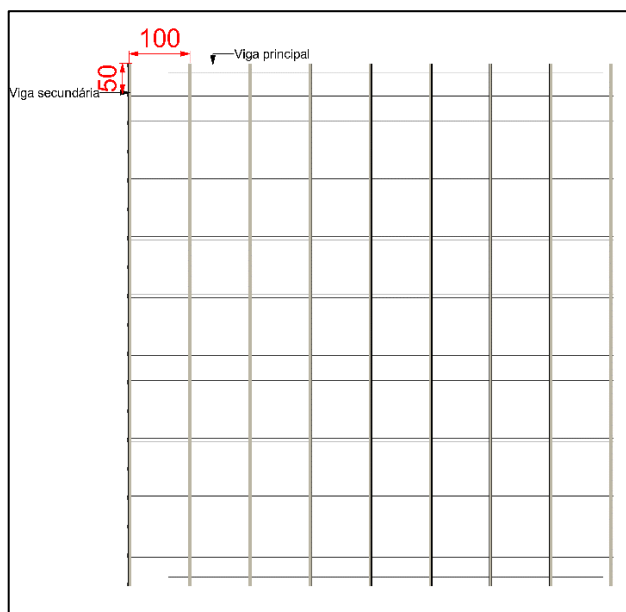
Planta de cobertura aparente para telha fibrocimento
